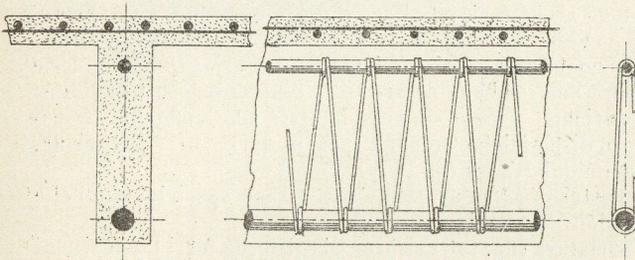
Nervatura, sistema Pavin de Lafarge.
